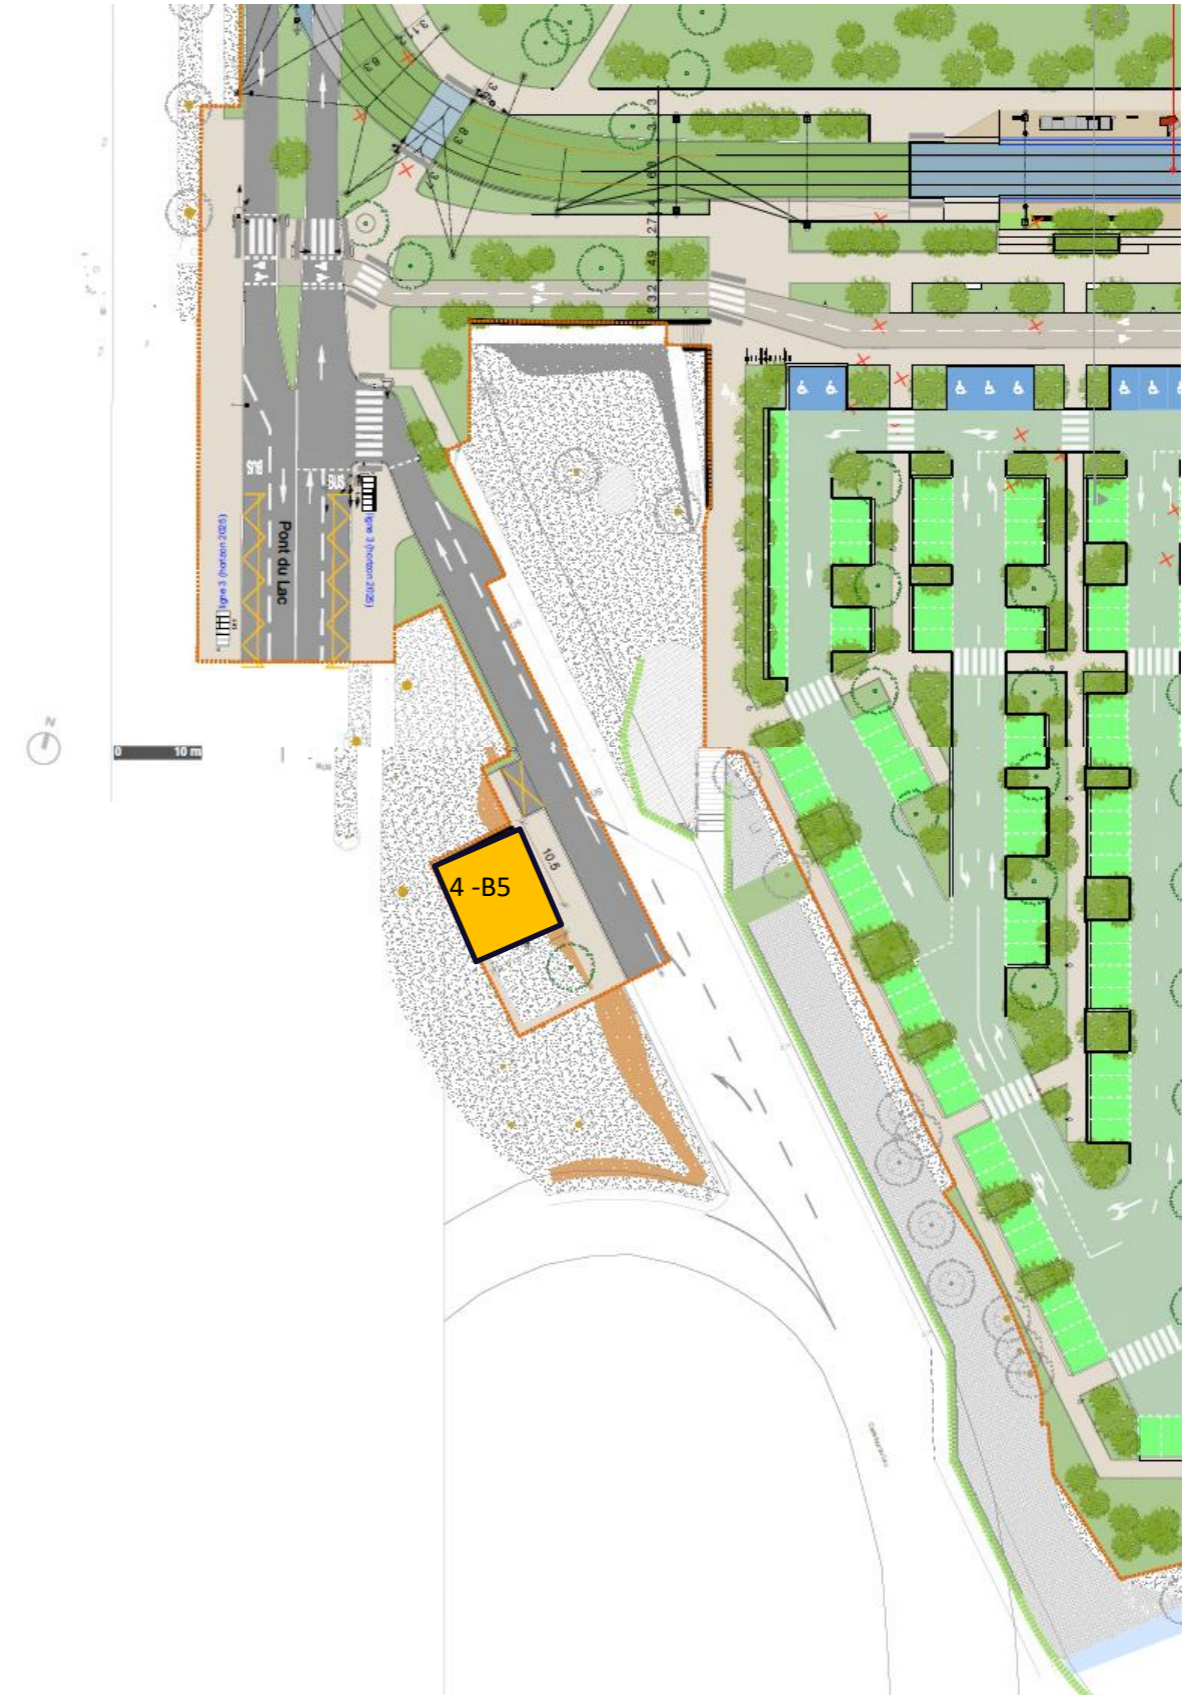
plan de localisation provisoire la station SSR 4-B5
